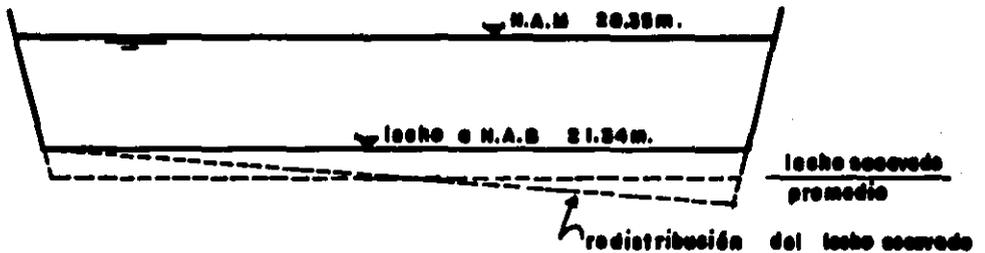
Redistribución del área de excavación (paso 4 del primer tanteo, segundo método). Esto es el estimado de peor excavación general.
